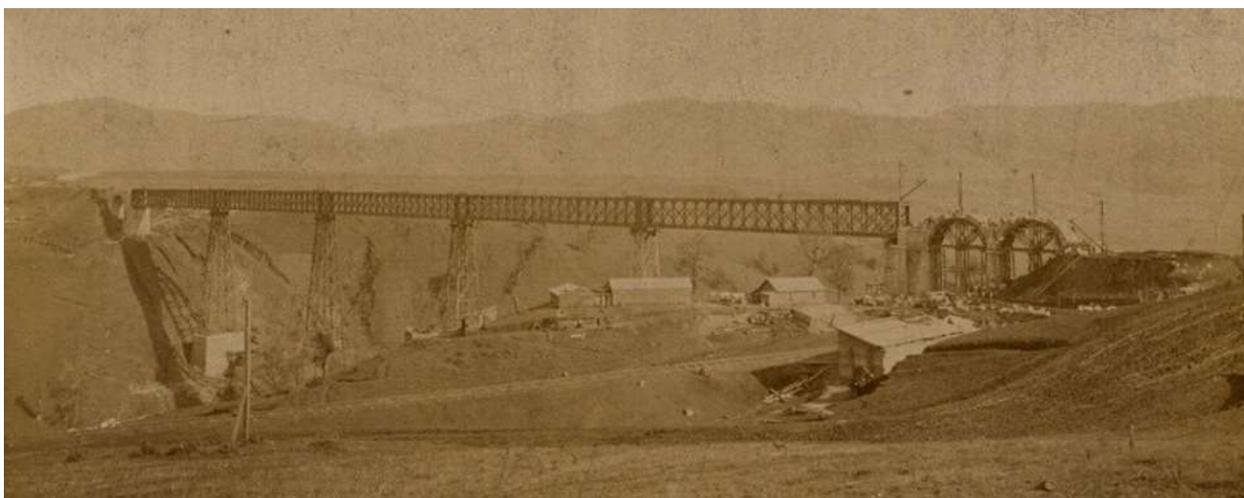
Viga armada sobre las cuatro pilas, 1 bóveda en el sur y 2 en el norte 1890.
